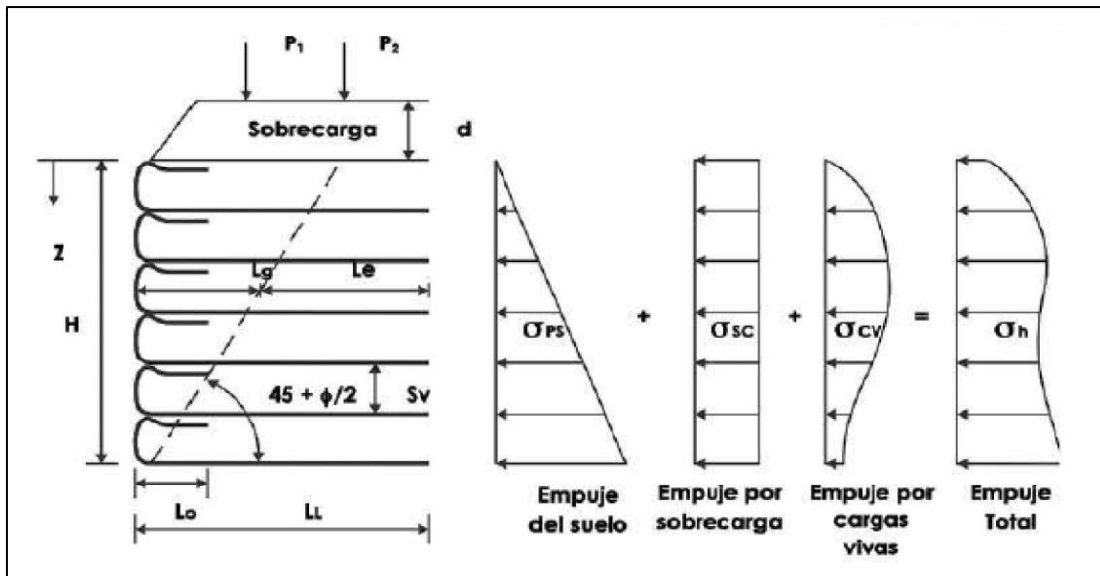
Esquema de muro de tierra reforzada con aplicaciones de cargas
